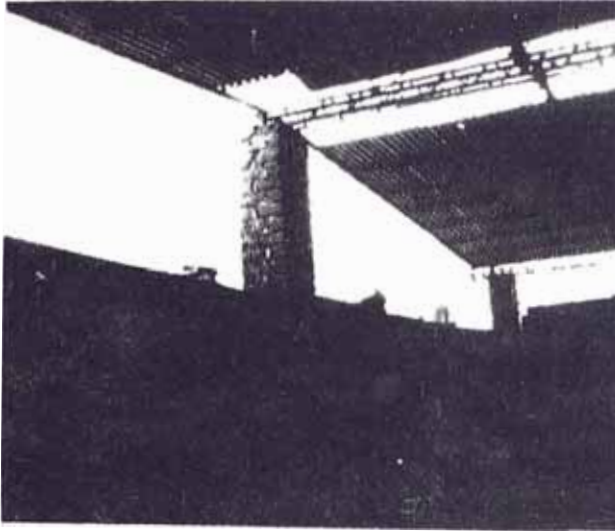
Mochetas de ladrillo que reemplazan a columnas sirviendo de apoyo al techo. Obsérvese en la vista interior un agrietamiento en la parte inferior de la mocheta.
